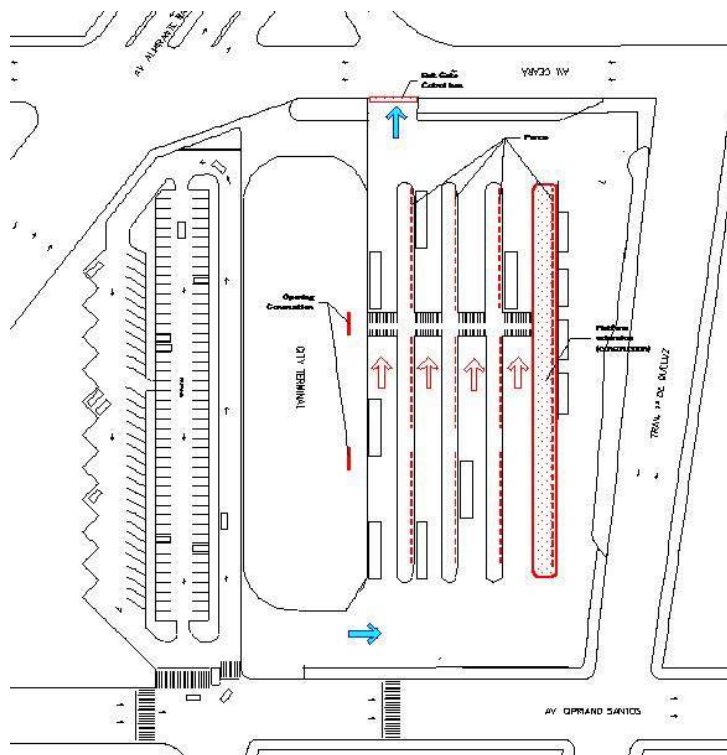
Planta do Terminal de São Braz - Requalificação
